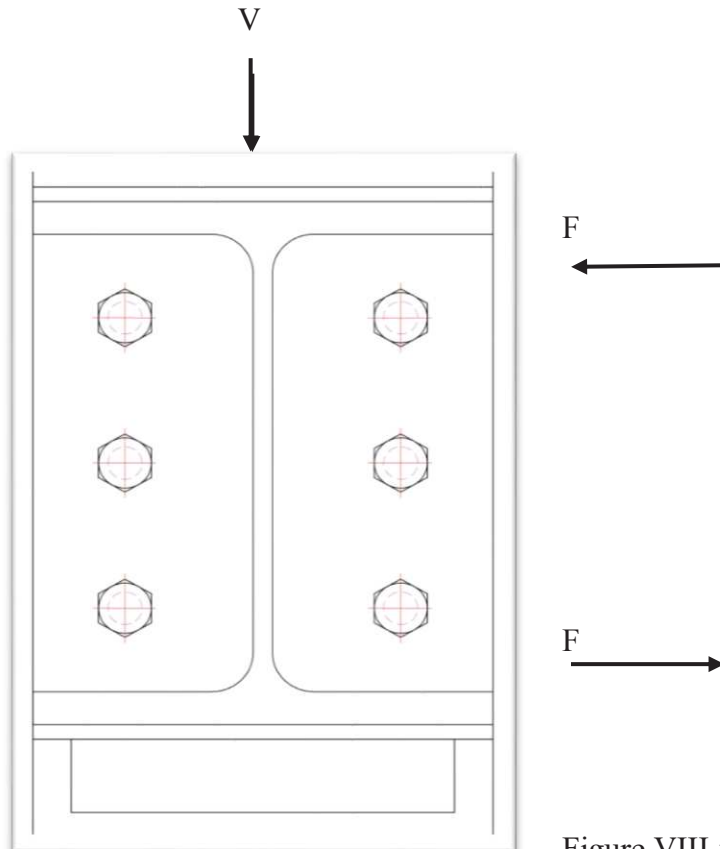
sollicitation sur l'assemblage platine-poutre
